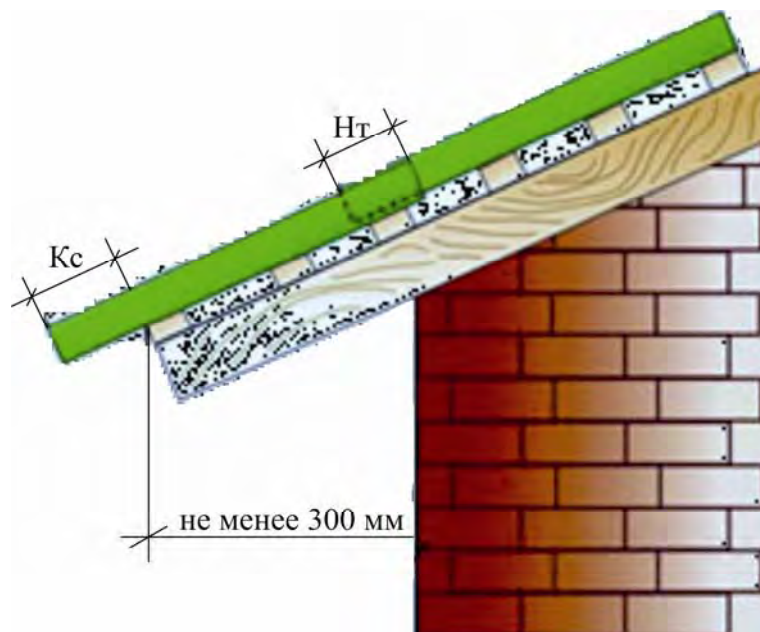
Монтаж кровли. Карниз из профнастила: H_T — нахлест горизонтальный, K_c — карнизный свес [13]
